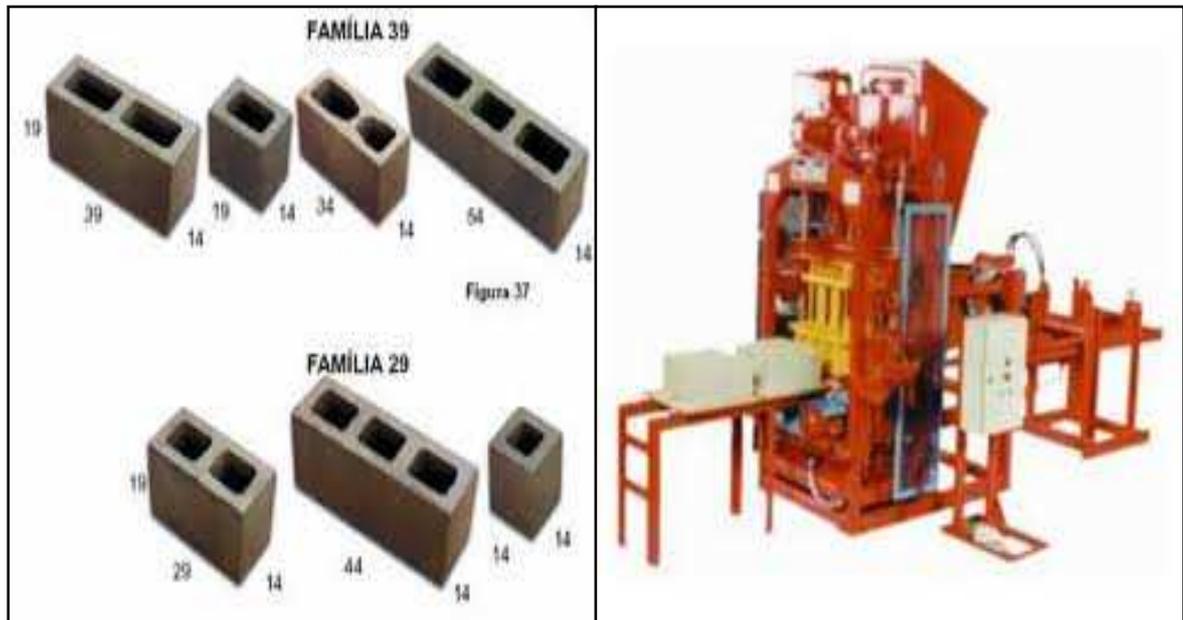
Tipos de blocos vazados de concreto e vibro prensa para fabricação
